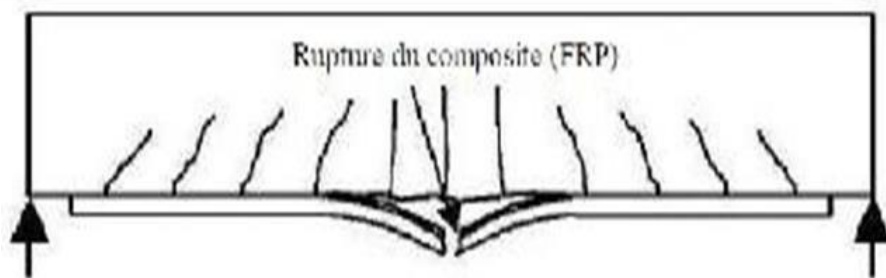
Schéma typique de poutre en BA réparée par le collage de composite endommagée par flexion et par la rupture de tissu.(MEBAREK and MENACER, 2022)
